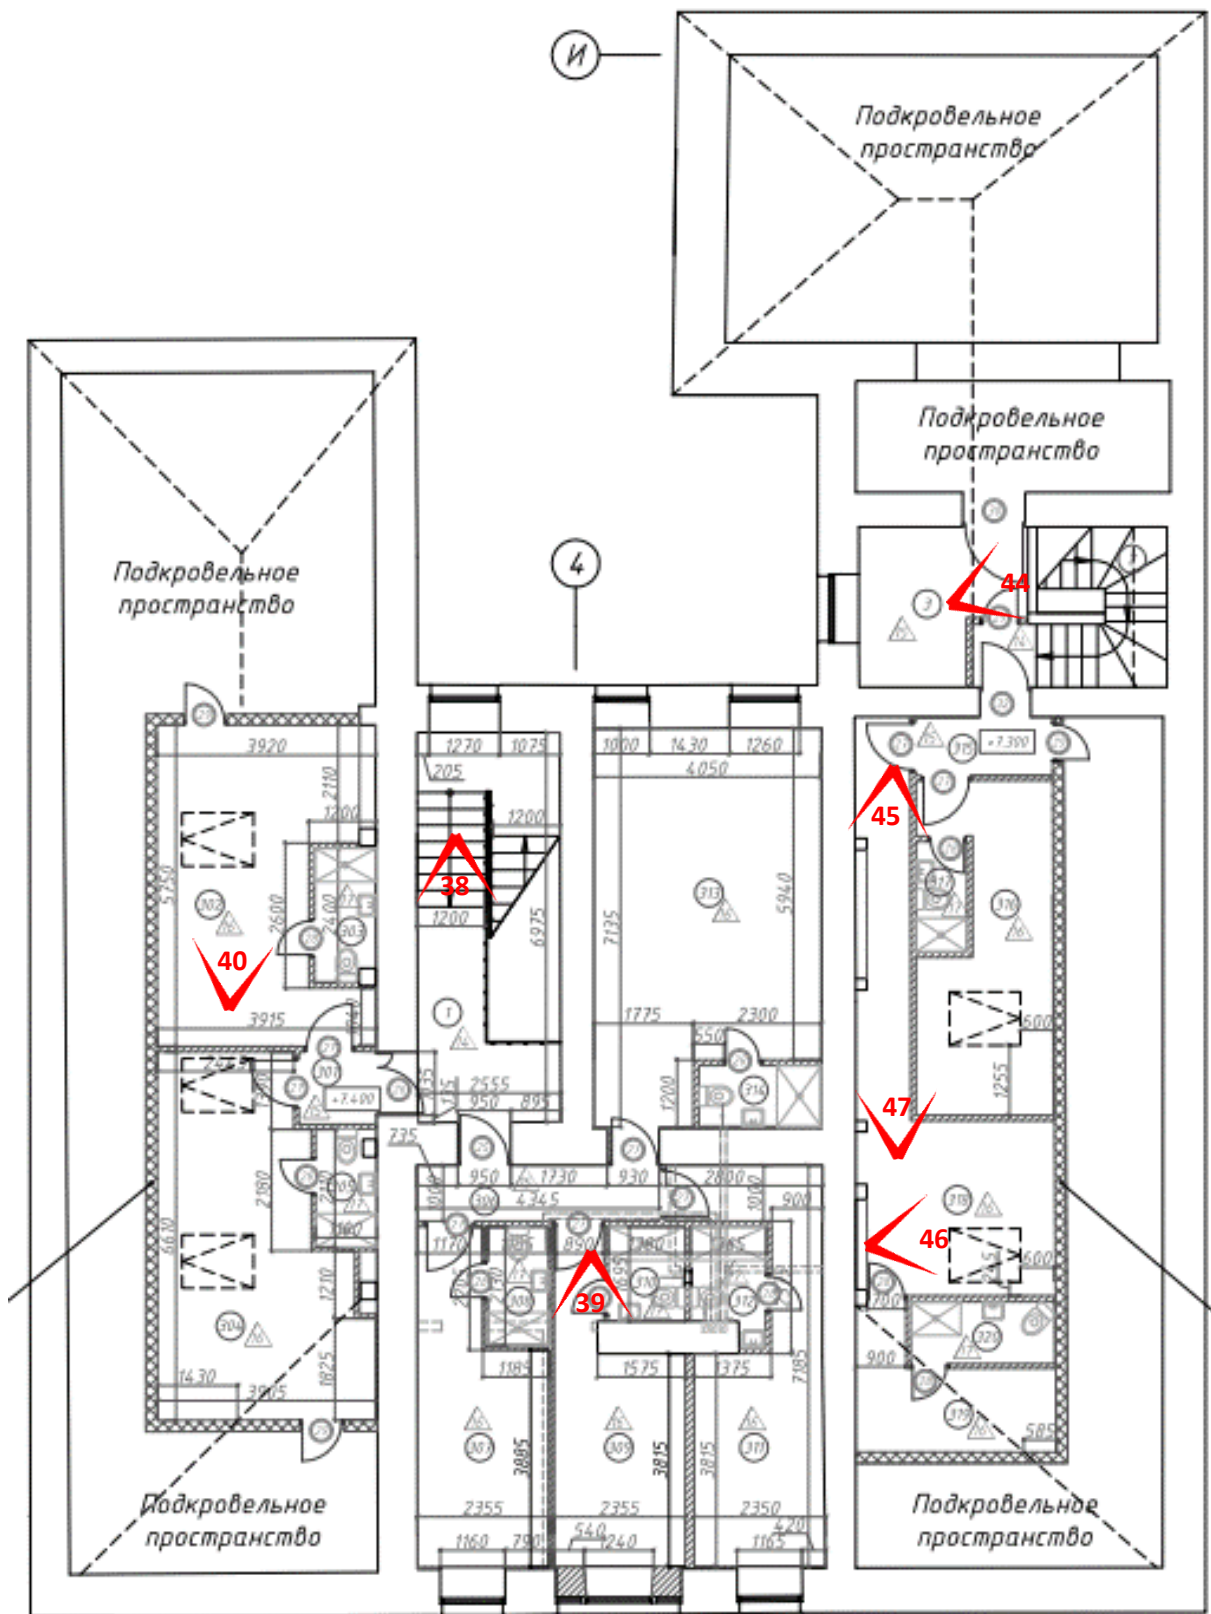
Схема фотофиксации на плане помещений, 3 этаж
